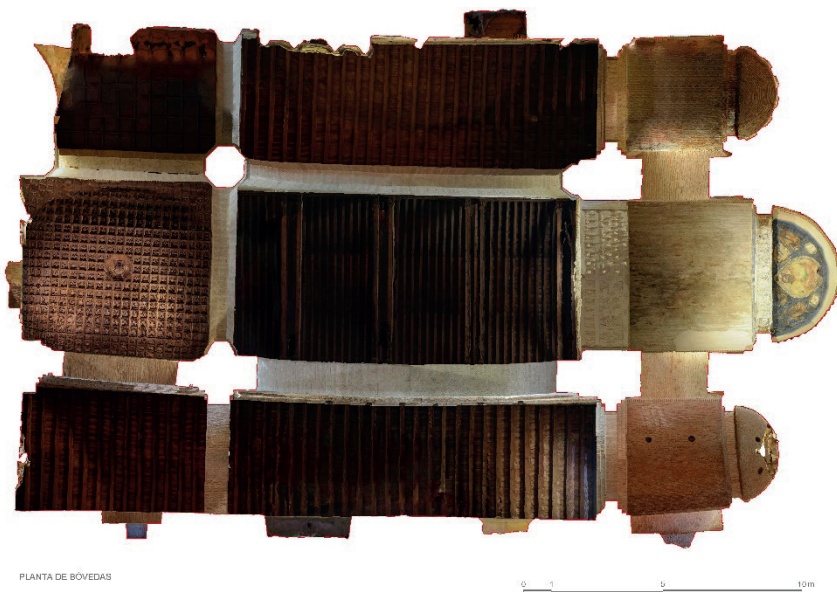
Planta de techos generada a partir del modelo de fotogrametría
